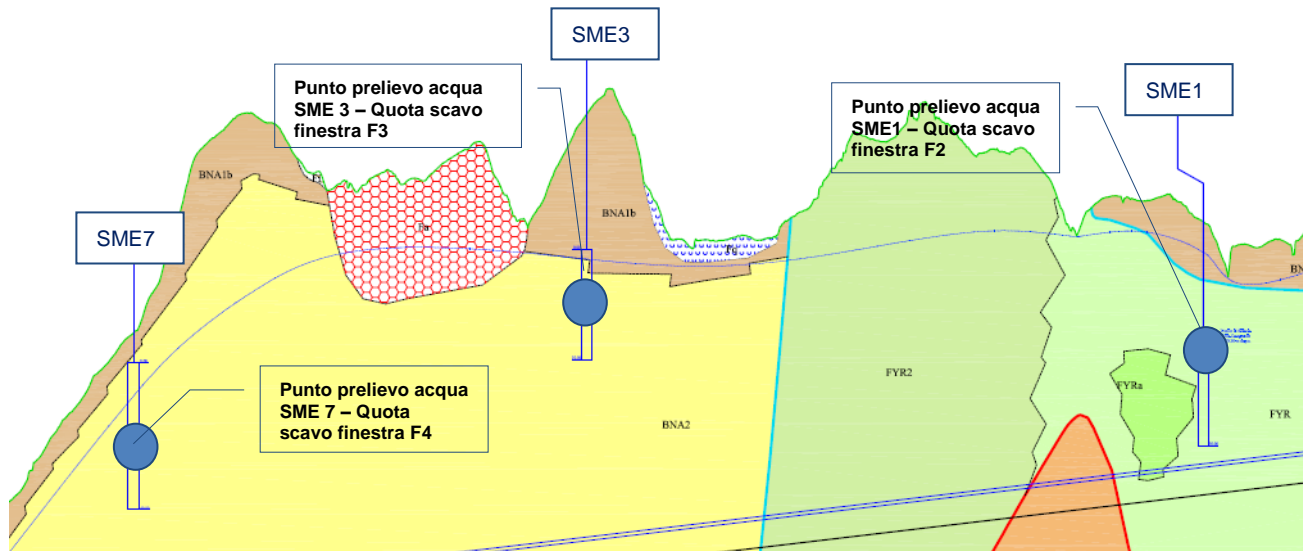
Galleria Melito: Posizione Piezometri SME1-SM3-SME37 rispetto alle finestre intermedie di accesso
